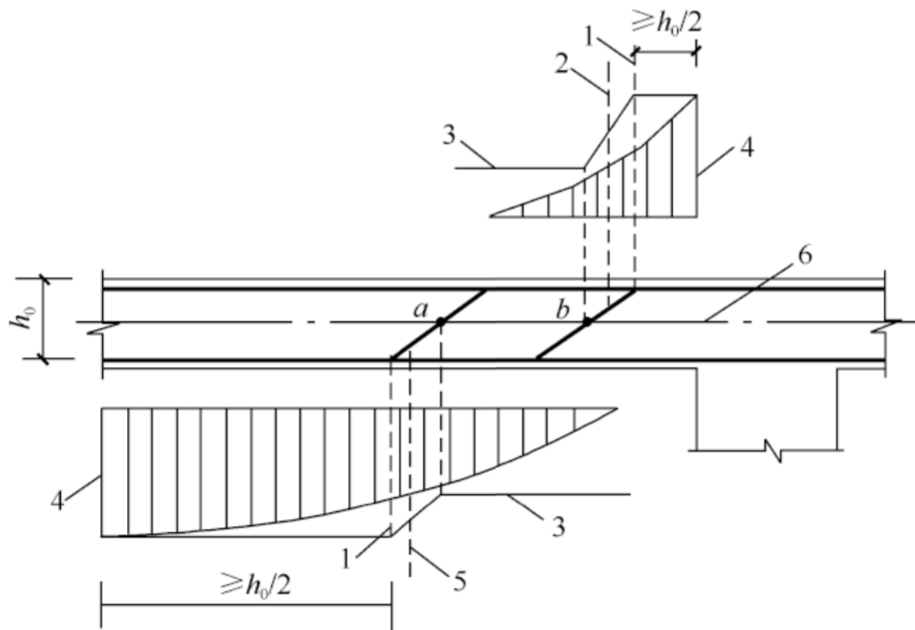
弯起钢筋弯起点与弯矩图的关系
